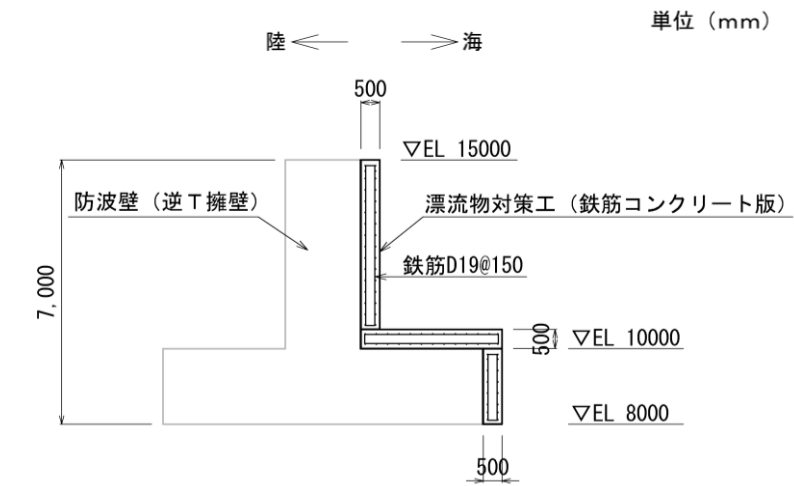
(2) 漂流物対策工 (鉄筋コンクリート版) の概略配筋図 (断面図)
